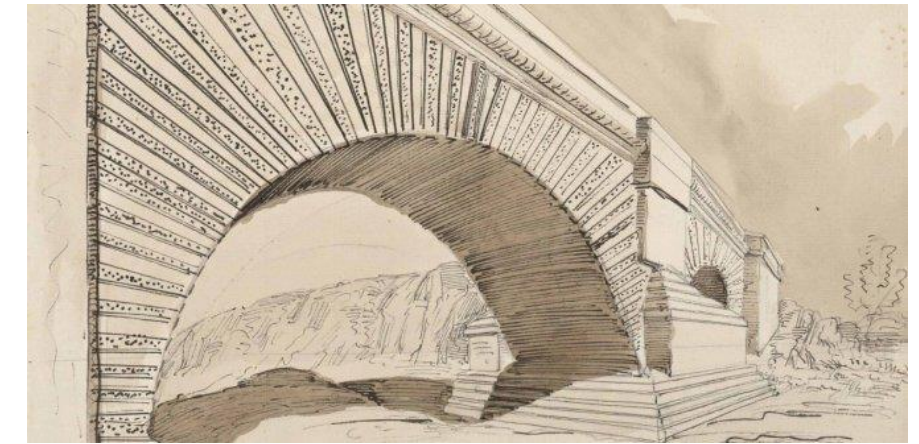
pont sur la Mosson tel qu'il apparaissait en 1822 (source : Midi Libre)
